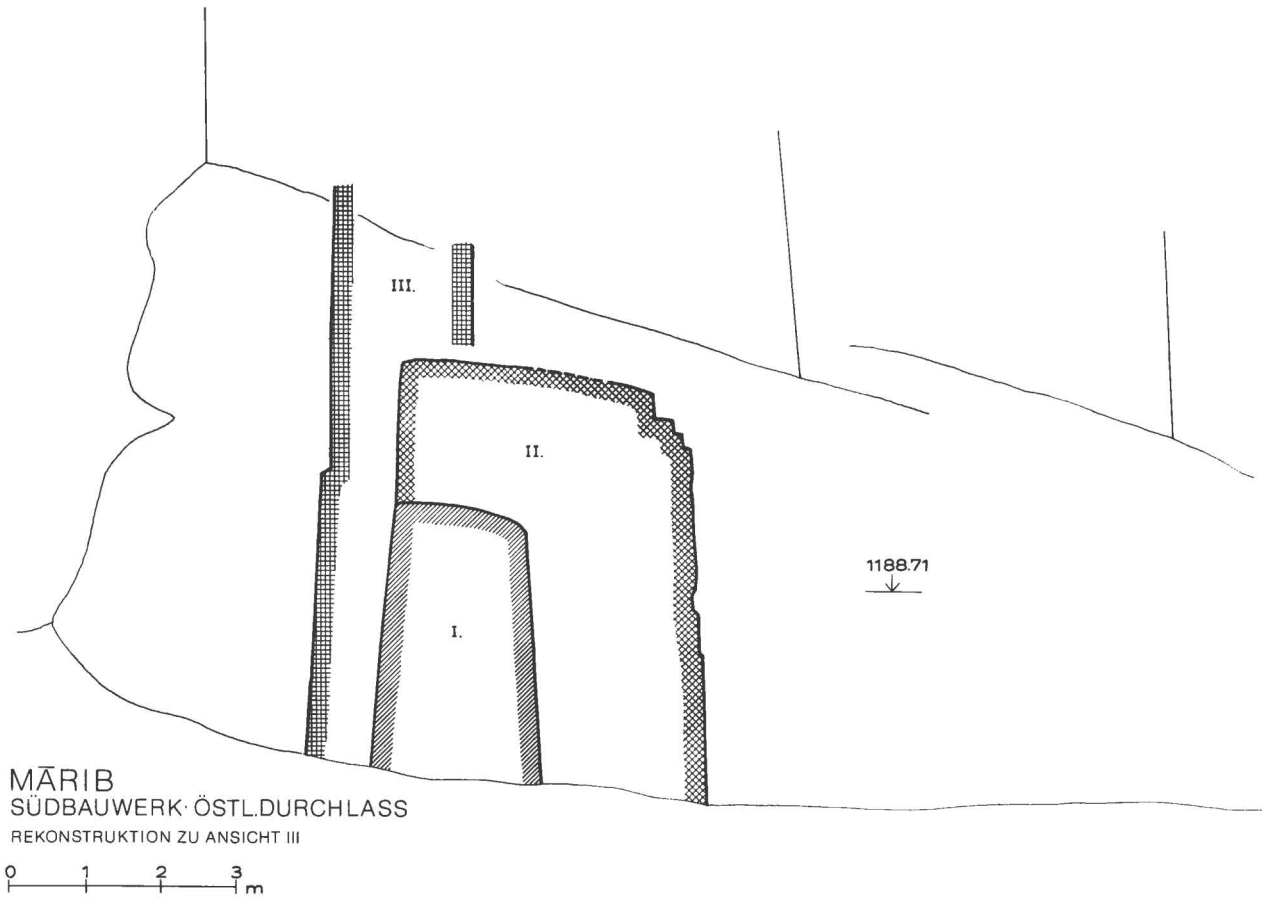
Märib, Damm. Südbauwerk. Östlicher Durchlaß. Rekonstruktion zu Ansicht III.
